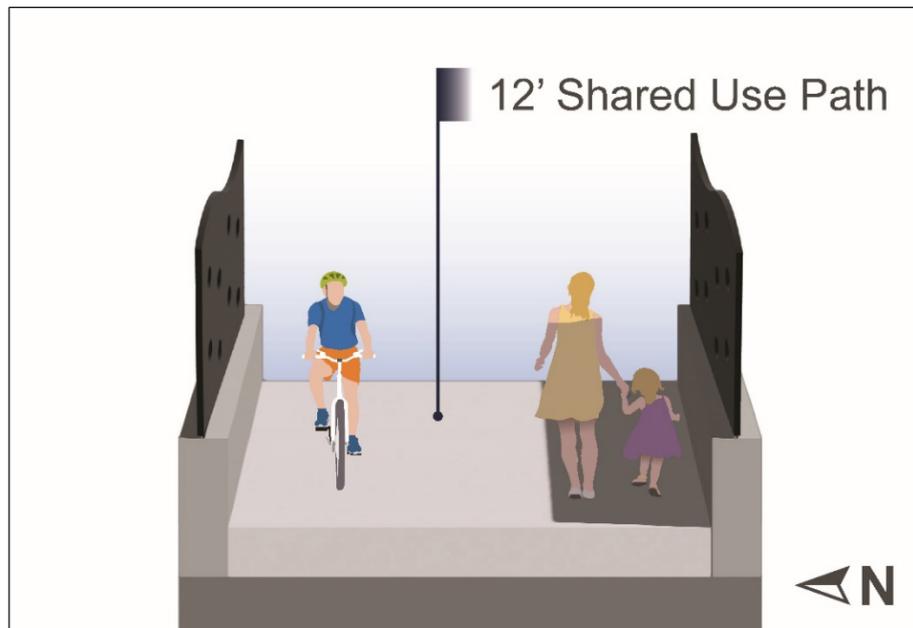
Alternativa de Acción: 800 West Woods Cross
